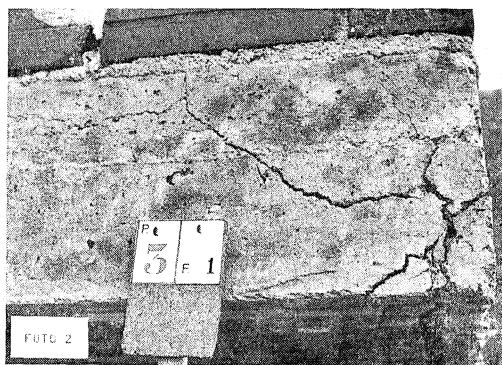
Muestras de agrietamiento por expansión en el canto de un voladizo.
